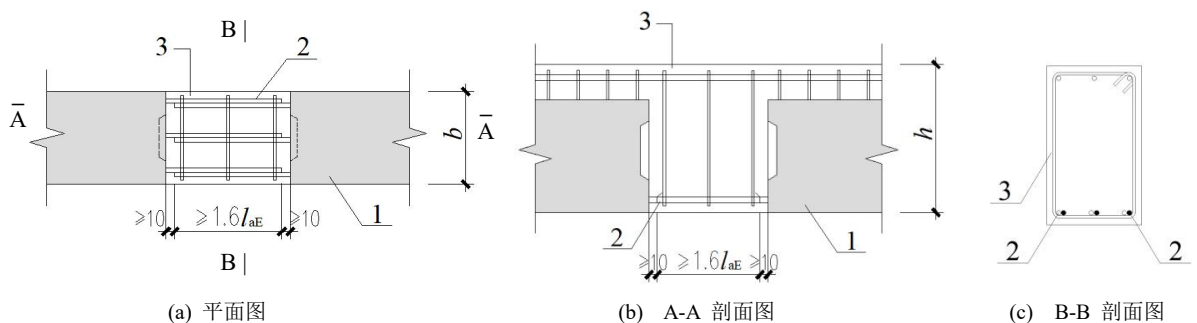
叠合梁错位连接后浇区搭接连接构造示意
